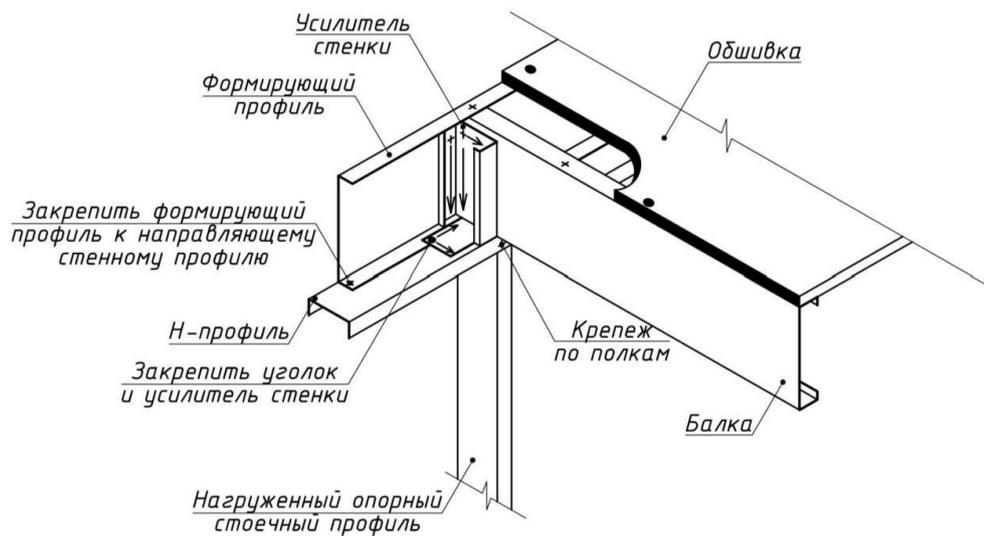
Схема крепления перекрытия к нагруженной стене
